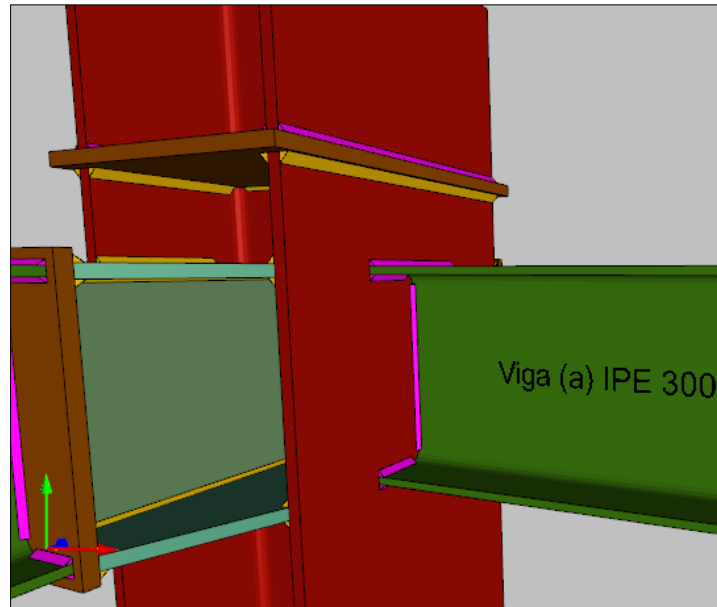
Vista de la unión a diseñar de la columna B5 y viga eje 5 tramo(B-E).
